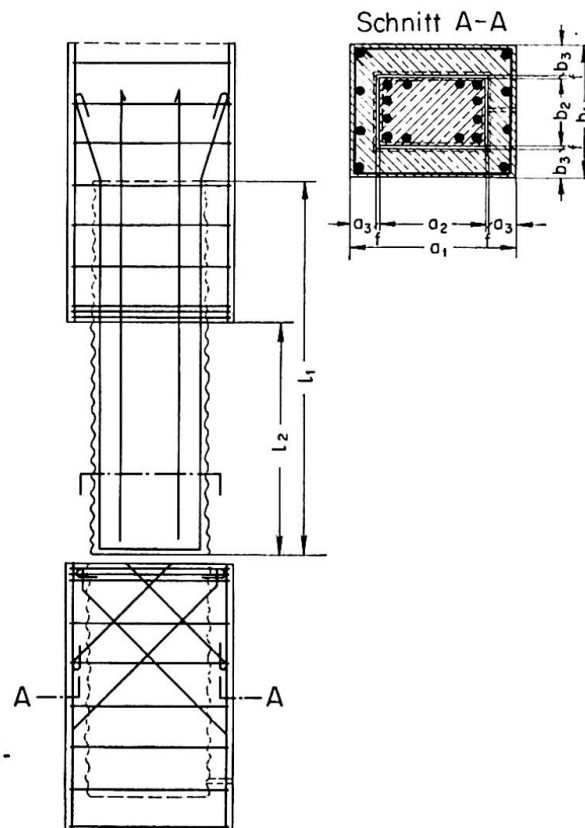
Abmessungen und Bewehrungsanordnung für den Stahlbetonzapfenstoß.
